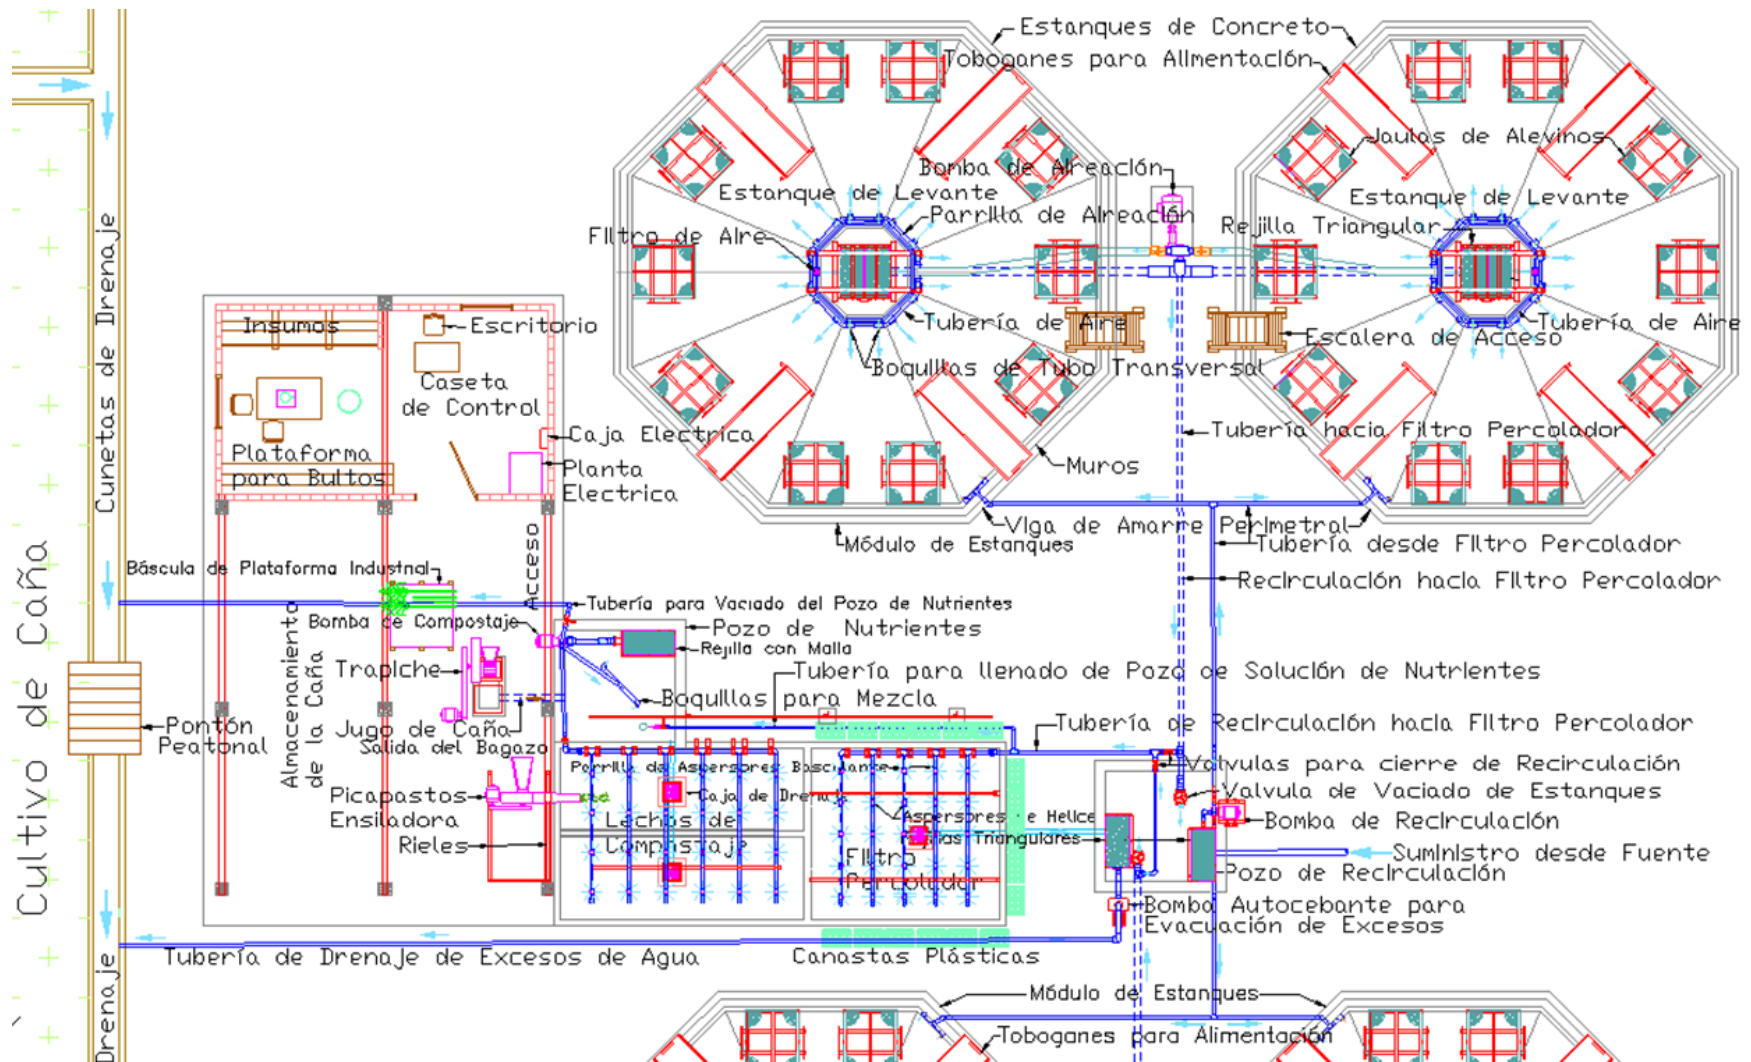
Vista en Planta de un Módulo de Estanques para la Cría de Tilapias
